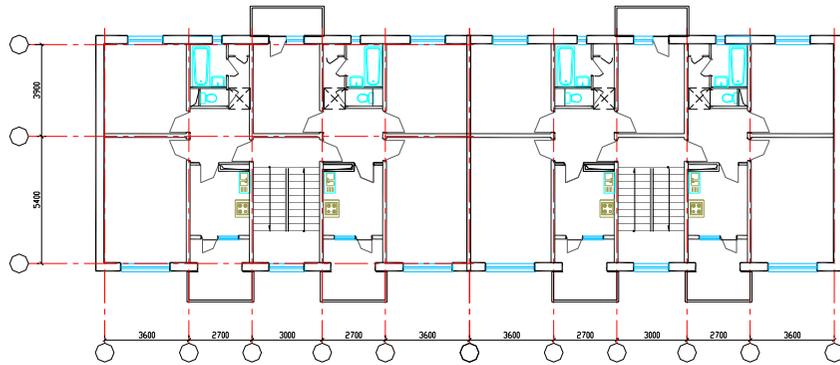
Grundriss Wohngebäudetyp 69(ohne Maßstab)
